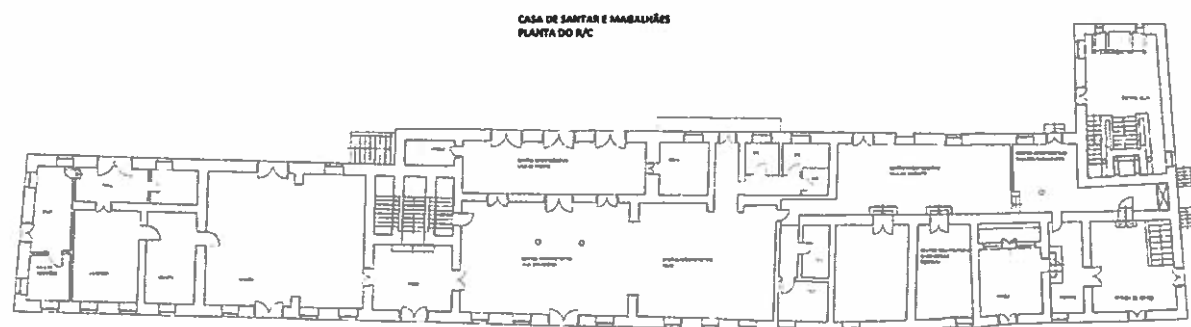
Levantamento do existente, planta do piso térreo, Arq. José Perdigão, setembro 1997 (?). Elementos remetidos pela CMN, para instrução da proposta, 24.02.2025.
